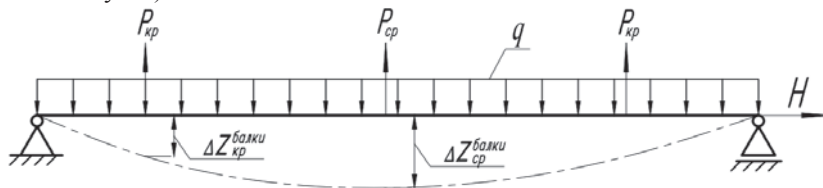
Расчетная схема к определению перемещения точек крепления подвесок к балке
